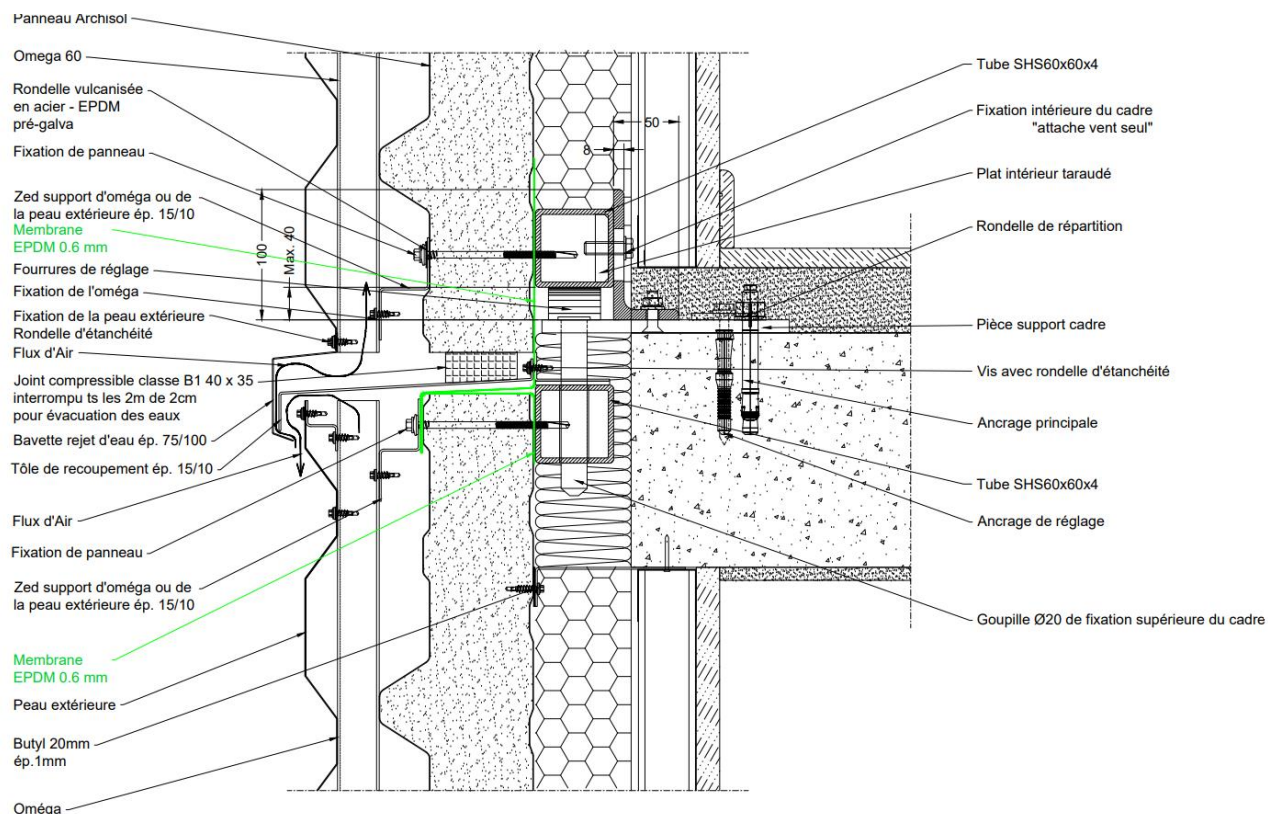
Coupe verticale sur la jonction horizontale entre modules D2B Archisol – Ancrage intermédiaire (vent seul) - Ossature en simple réseau
